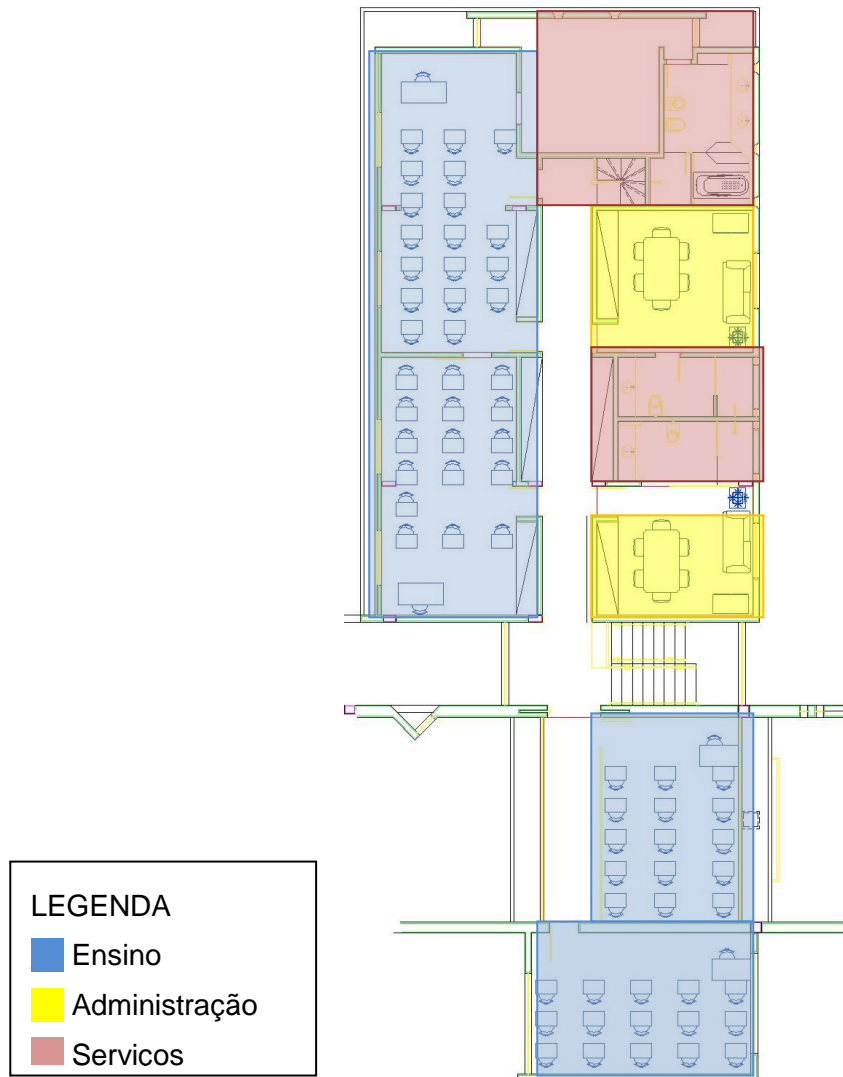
Planta Baixa Primeiro Pavimento. Fonte: Projeto Arquitetônico.
